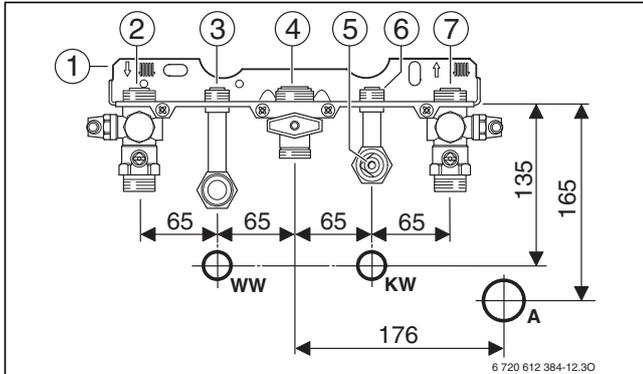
Aufputzanschlüsse mit Wandabstand 60 mm
